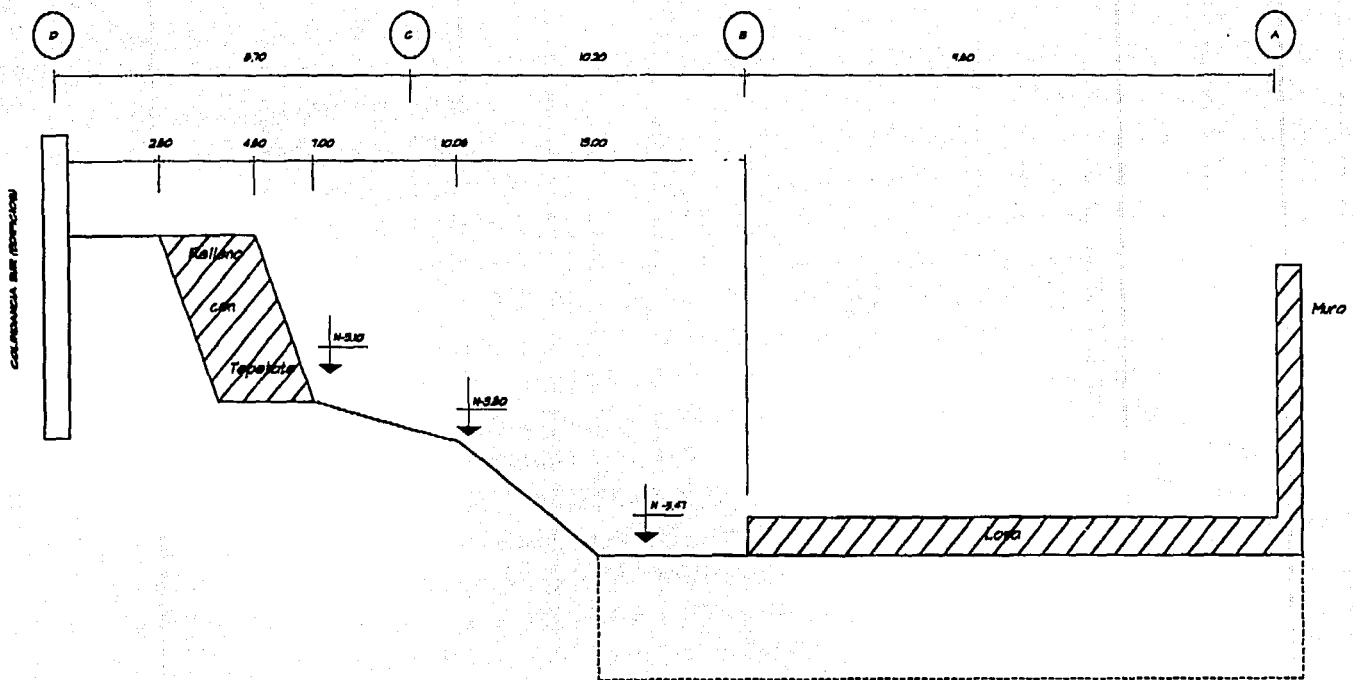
CORTE ENTRE EJES A-C PIE
